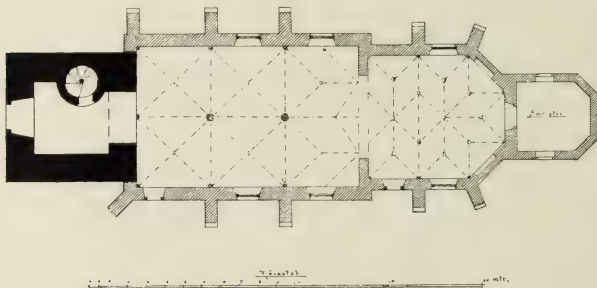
Mudscheid. Kathol. Pfarrkirche. Grundriss.
